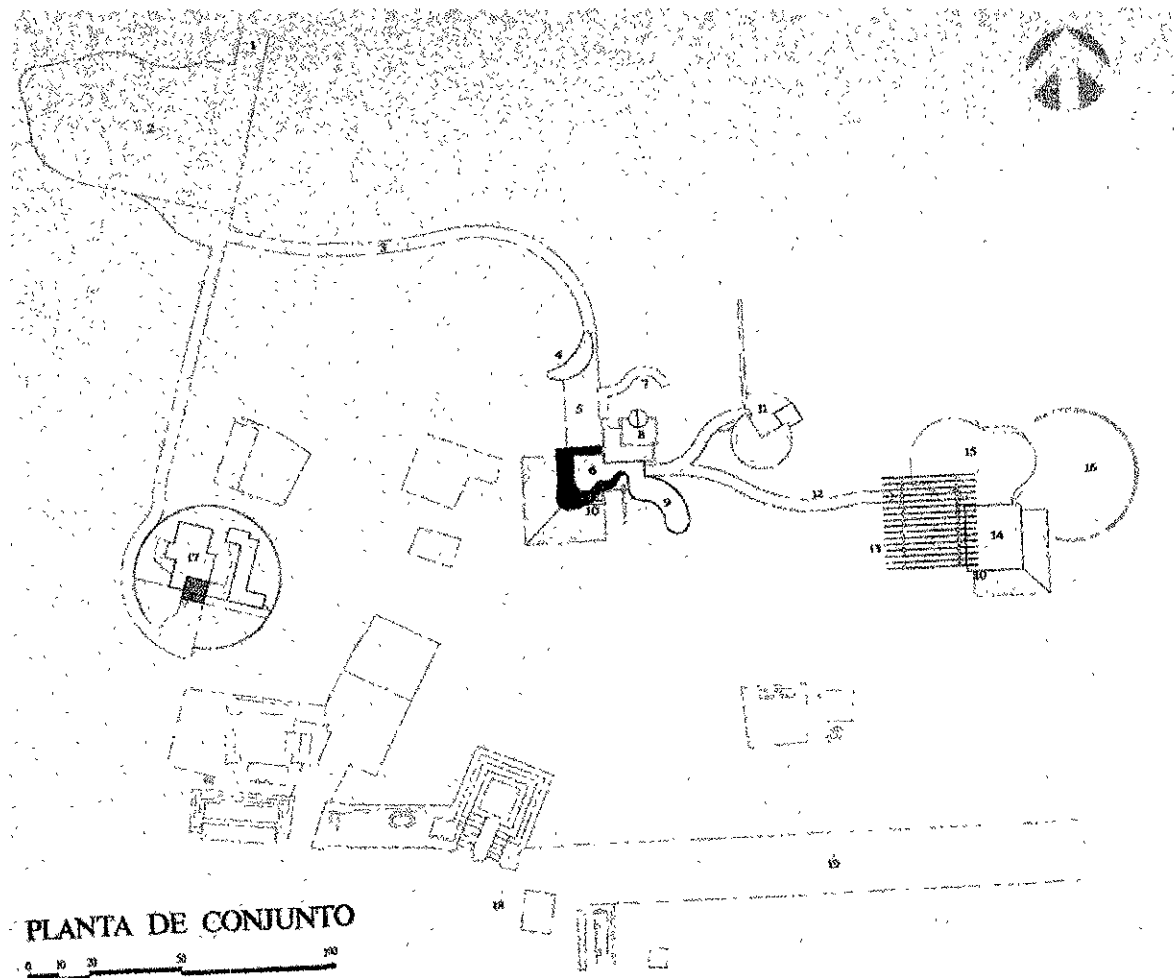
Planta de conjunto del Museo del Pueblo Maya.
